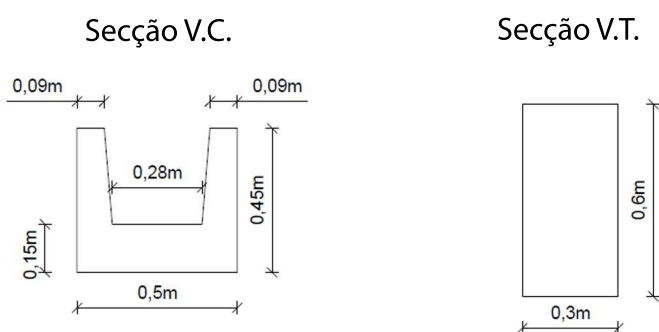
Secções das vigas caleira e das vigas de travamento
